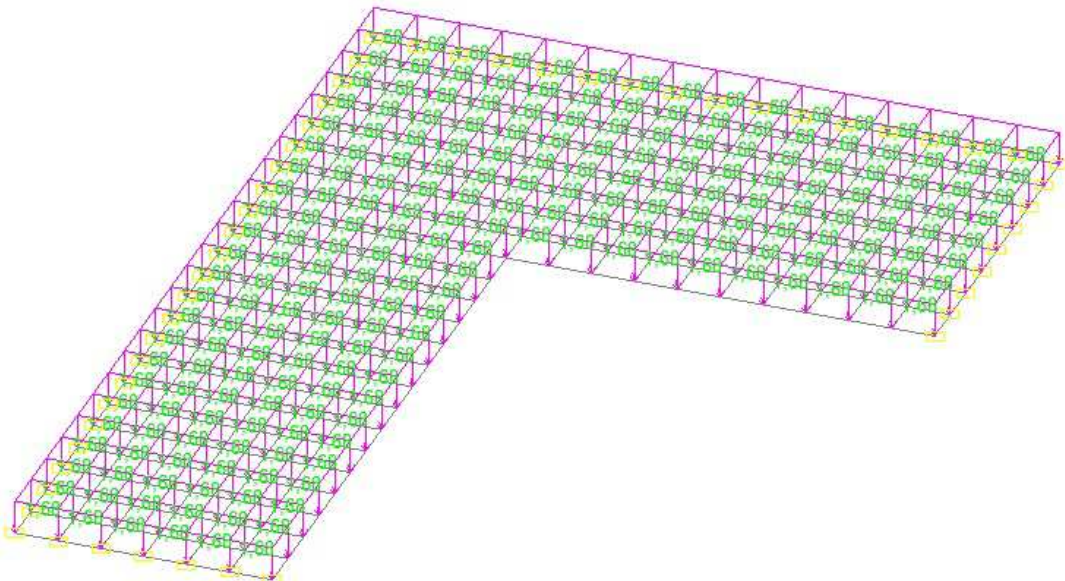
Схема загрузки плиты нагрузкой от веса пола
